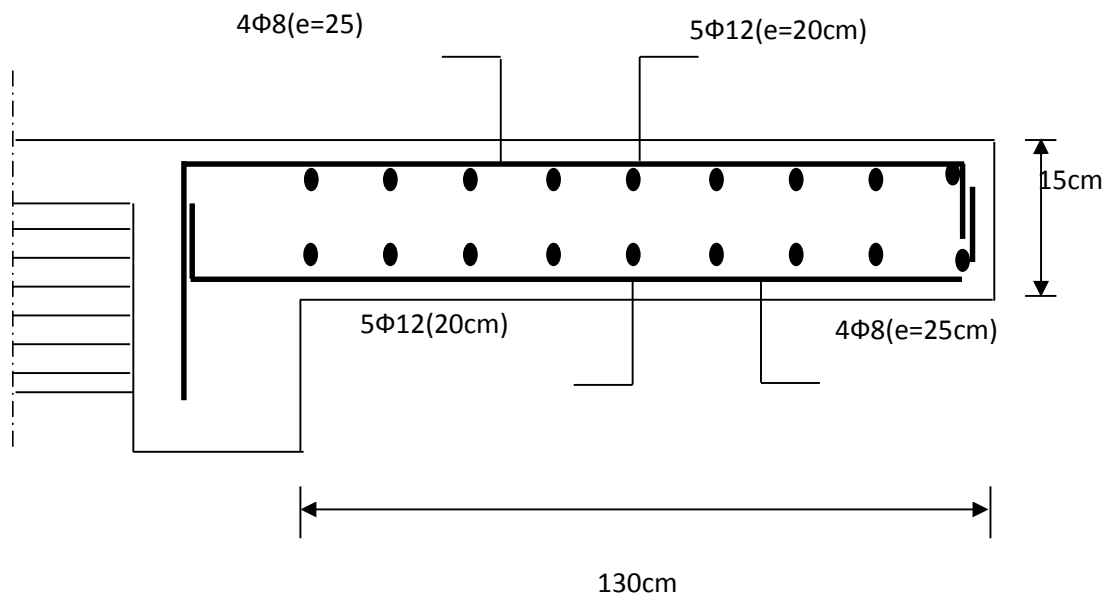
Ferrailage du balcon reposant sur deux appuis
